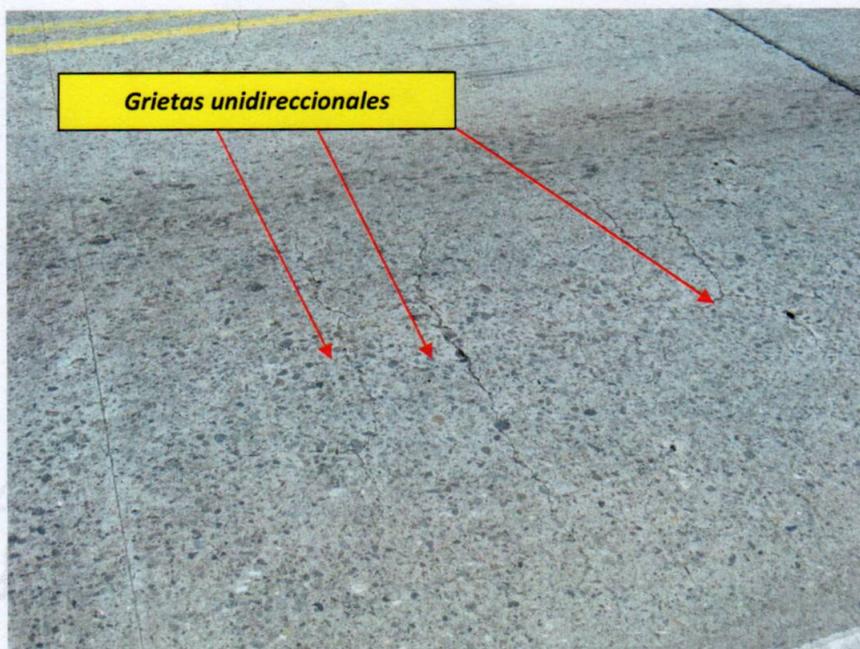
Grietas unidireccionales en la superficie de rodamiento
